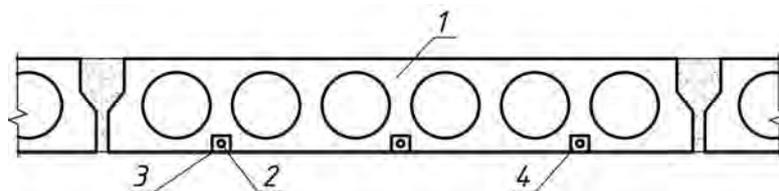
Установка дополнительной арматуры на полимеррастворе: 1 – усиливаемая плита; 2 – дополнительные арматурные стержни; 3 – борозды в бетоне, вырезанные фрезой; 4 – защитно-конструкционный полимерраствор
